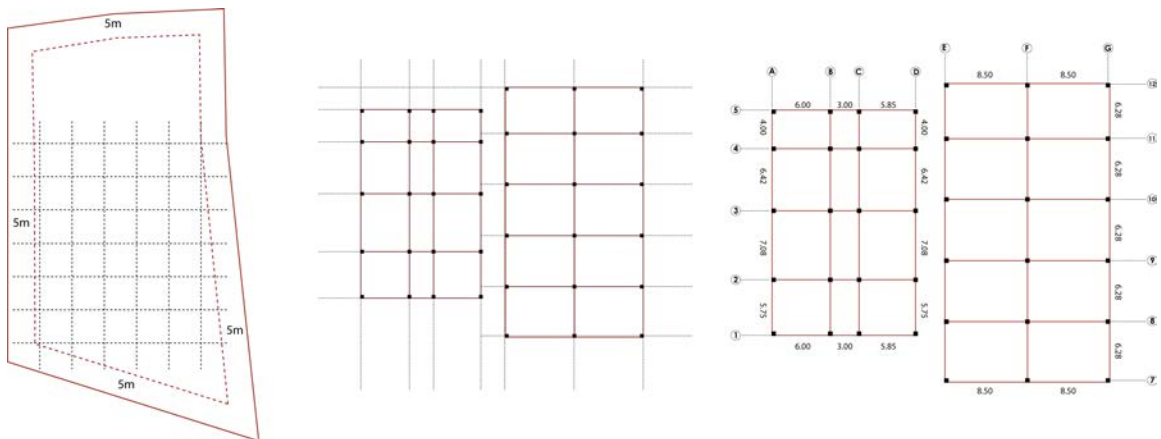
Malla de modulación del proyecto: Elaboración: Propia.
